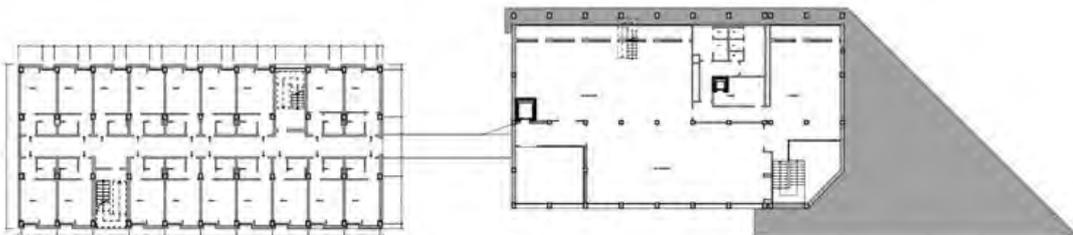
pianta del primo piano dell'Hotel San Faustino
